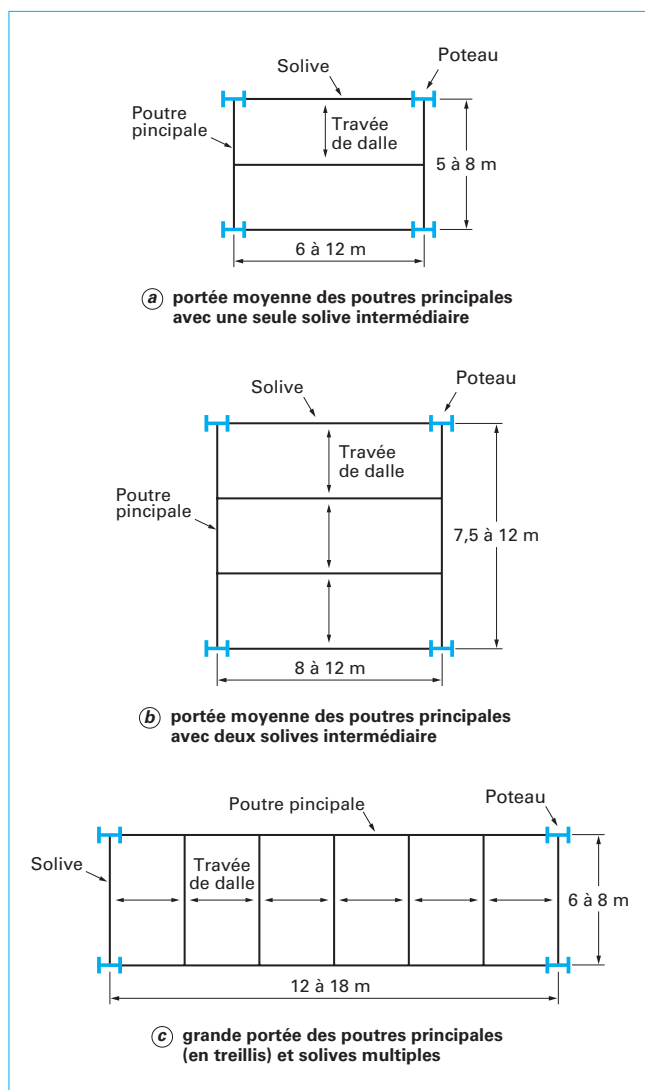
Dispositions courantes d'une trame de poutres (entre quatre poteaux)
